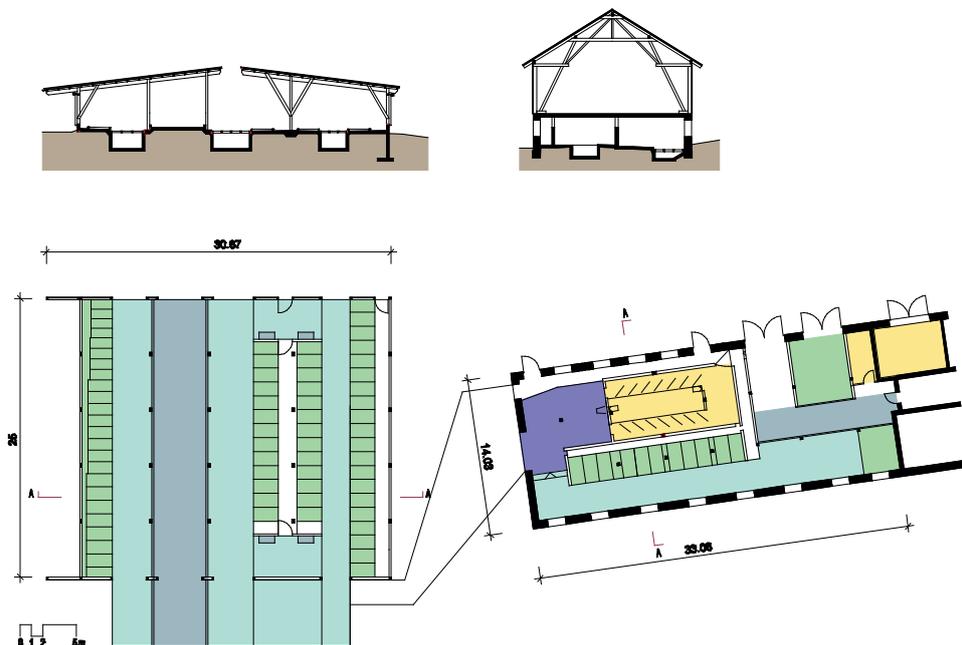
Grundriss und Schnitte des umgebauten Anbindestalls und der neu gebauten mehrhäusigen Liegehalle am Betrieb Holzner
